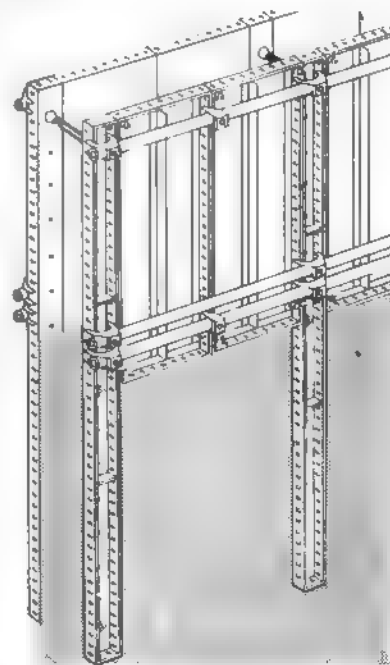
Sistema Acrow Wall Form. Esquema de armado.
